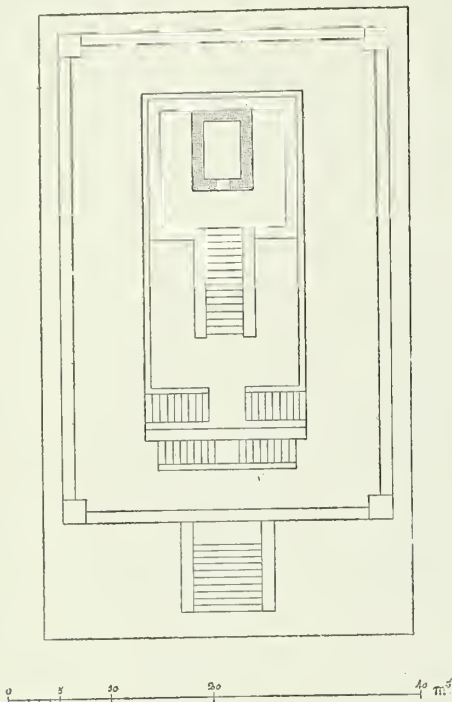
TEMPLO CALDEO DE PLANTA RECTANGULAR (RECONSTITUCIÓN DE CHIPIEZ, PLANTA)
